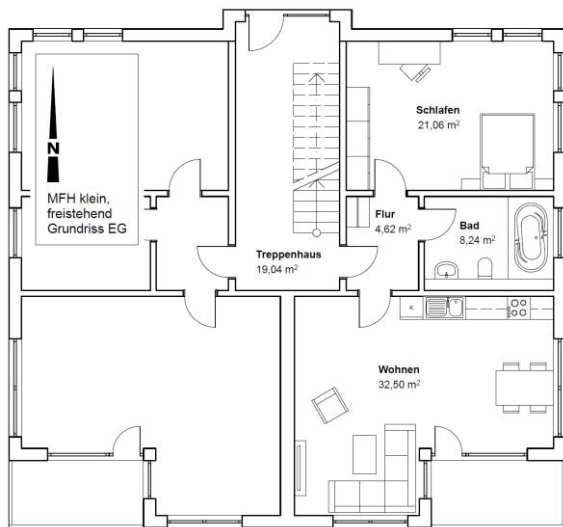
Grundriss Erdgeschoss des kleinen freistehenden Mehrfamilienhauses, erstellt und modifiziert auf Basis von (Klauß et al., 2010).
